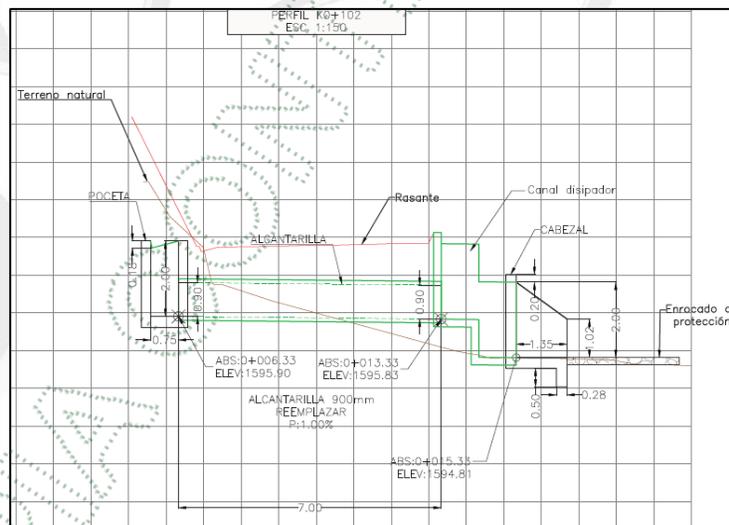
1(2)	Tipo de la obra	Tubería abscisa K00+102
